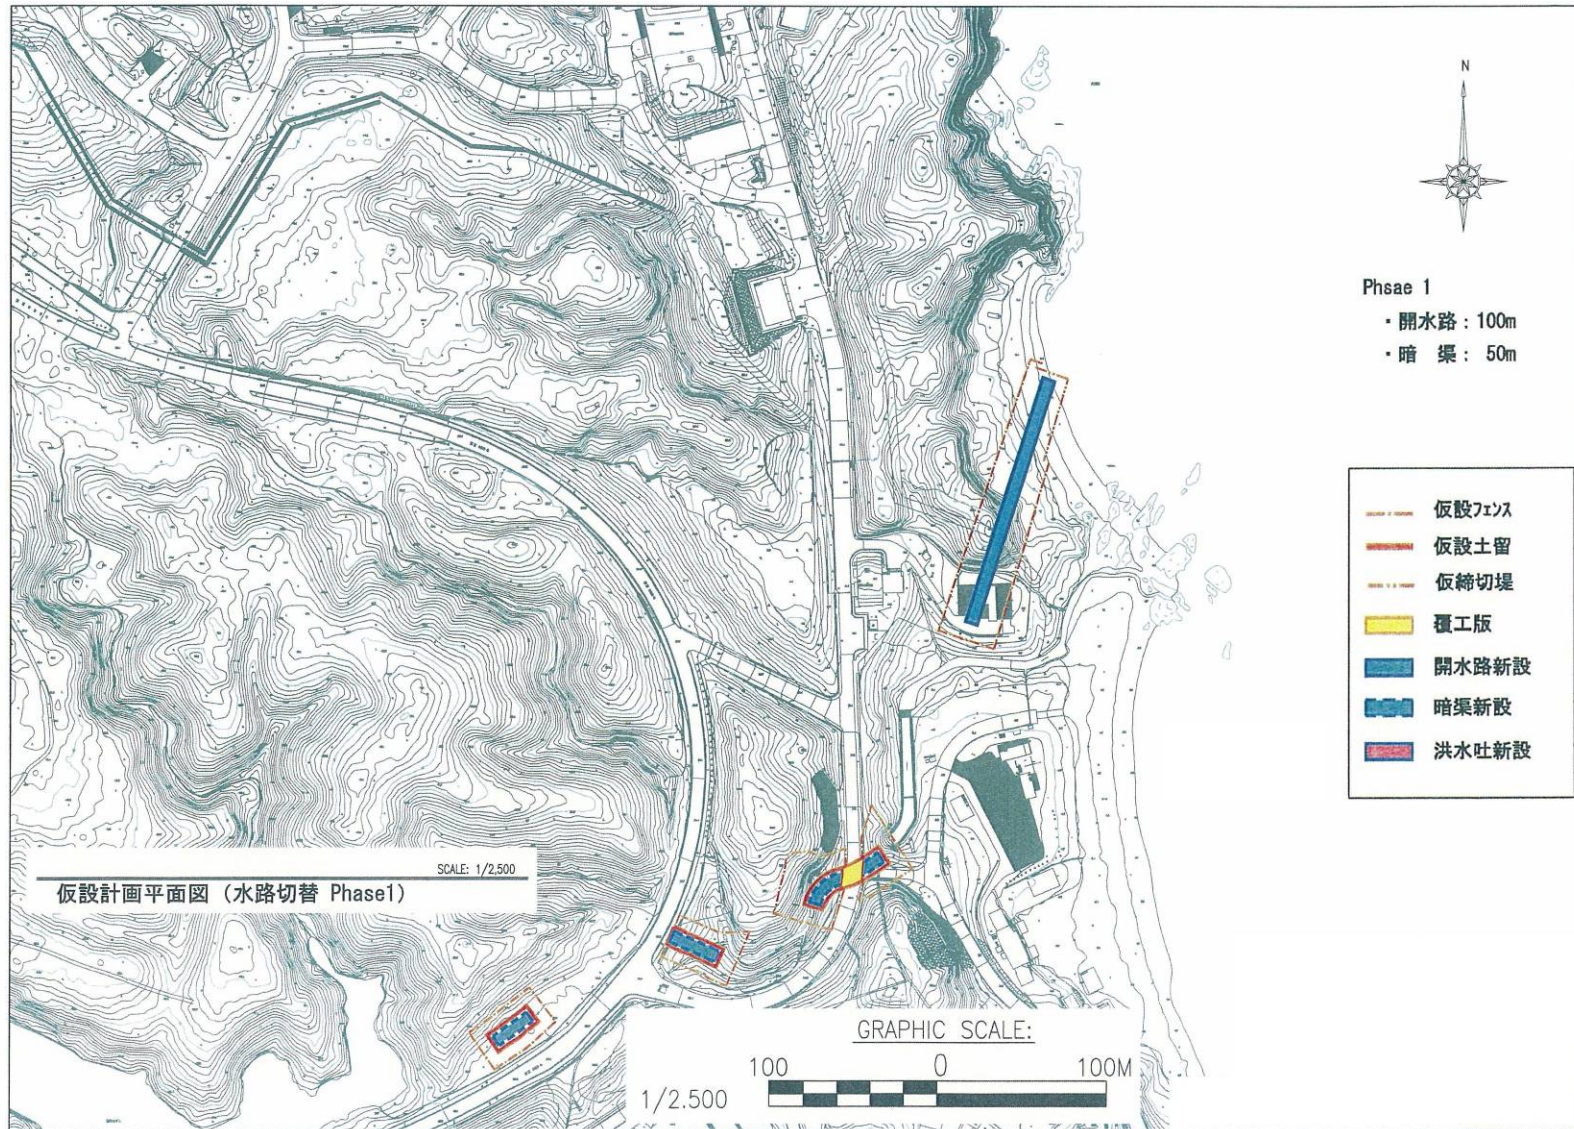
(1) 美謝川の切替え仮設計画平面図（Phase1）
